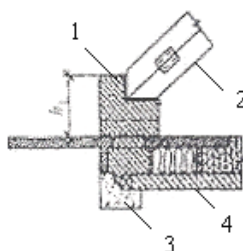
Узел опирания деревянной полуфермы мансардной надстройки на обвязочный пояс из монолитного железобетона
